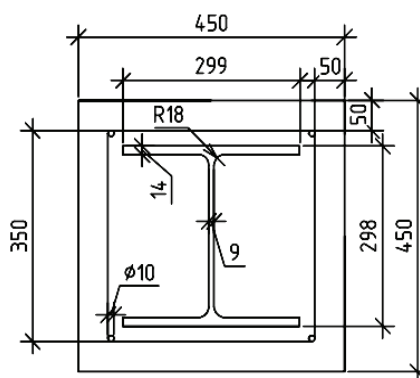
Схема колонны квадратного сечения с жестким внутренним армированием (вариант 4) – двутавр в квадратном сечении.
